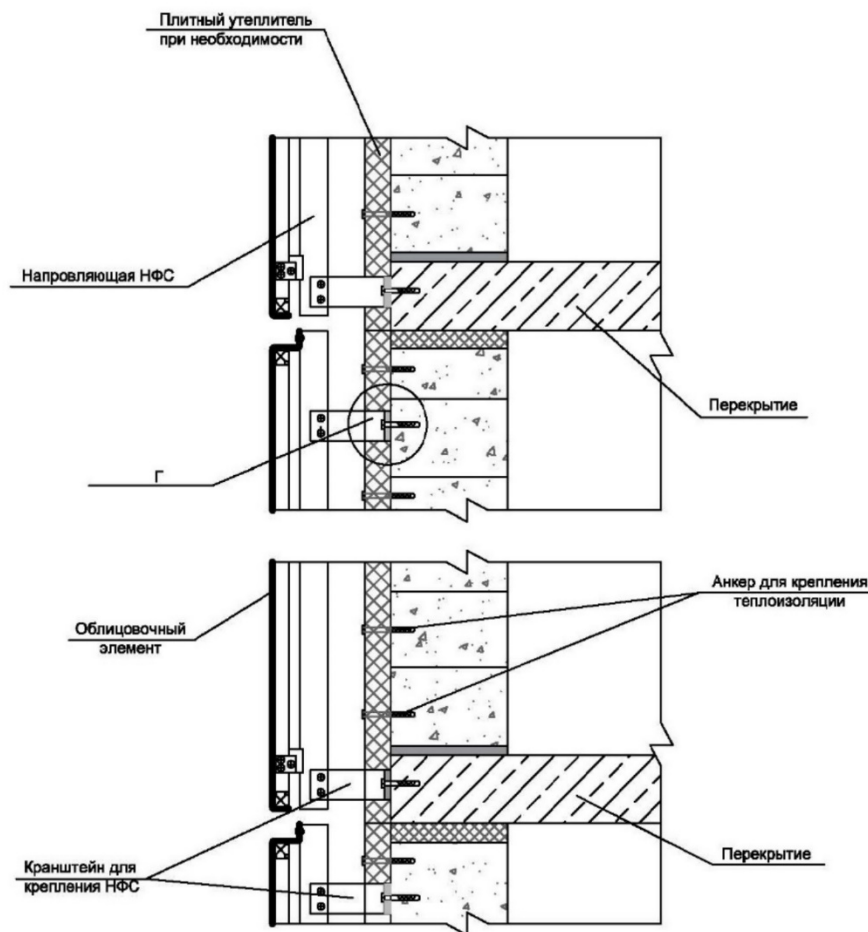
Примеры закрепления каркаса НФС к торцам междуэтажных перекрытий и к стенам из ячеистобетонных блоков
